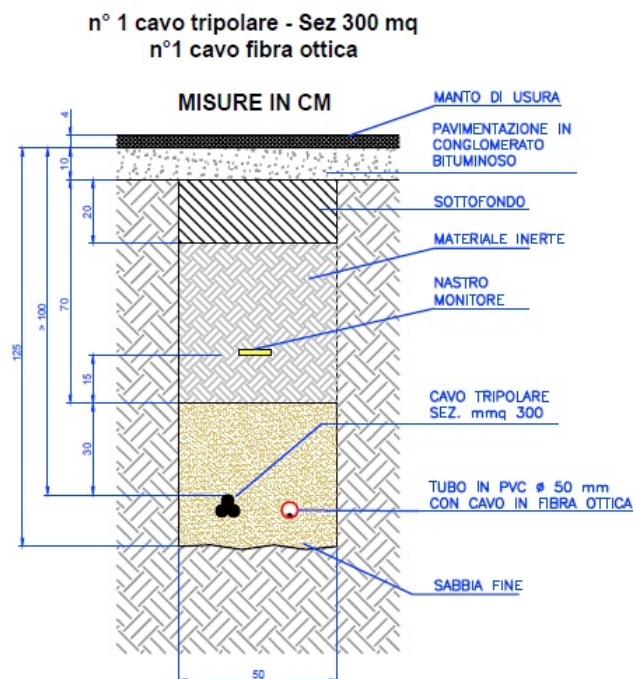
Sezione tipo cavidotto con terna di cavi tripolari su strada asfaltata estraparco
